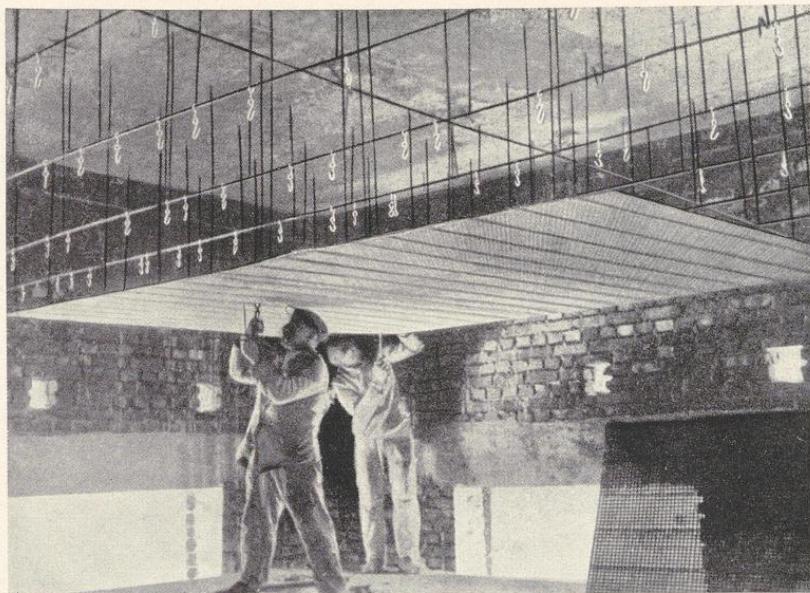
Rabitzdeckenkonstruktion mit aufgehängten Staußziegel-Gewebematten
